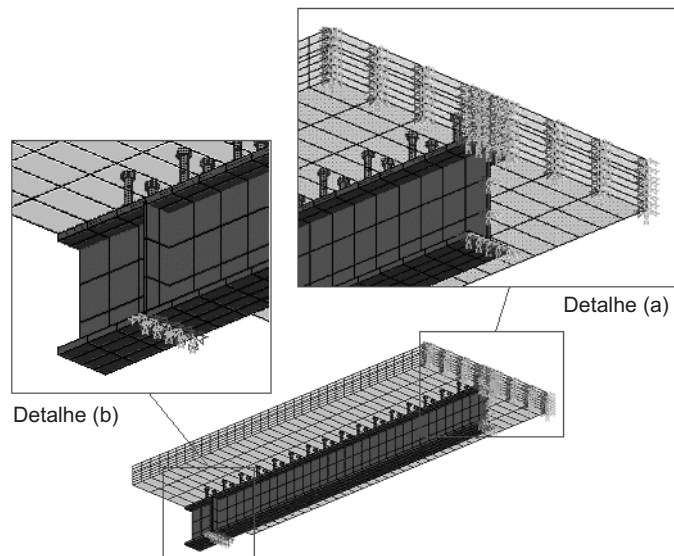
Vinculações: Detalhe (a) simetria e Detalhe (b) apoio móvel.
